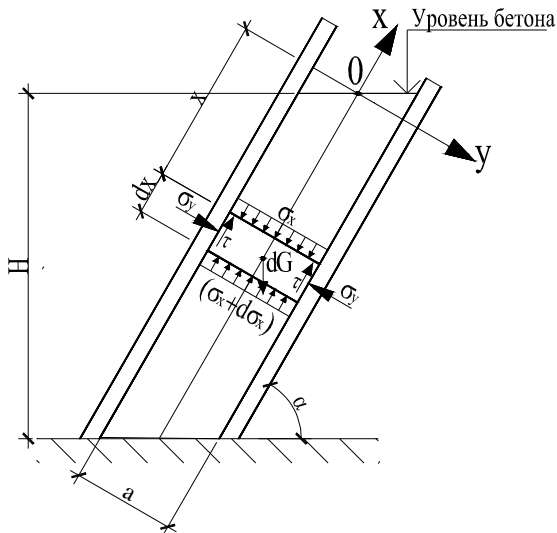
Расчетная схема определения давления бетонной смеси на наклонную опалубку
